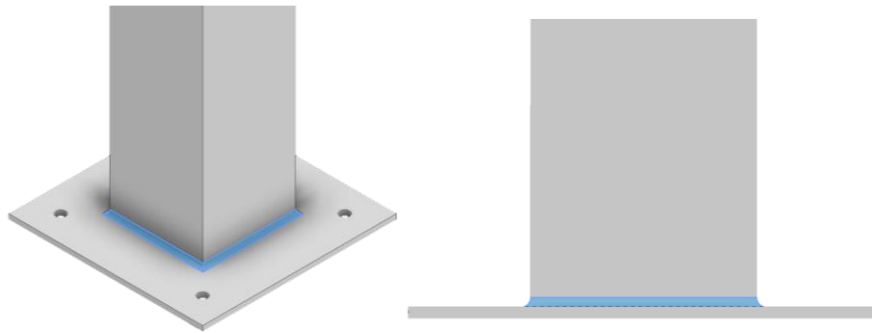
34 Soldadura de Columna - Placa Base
